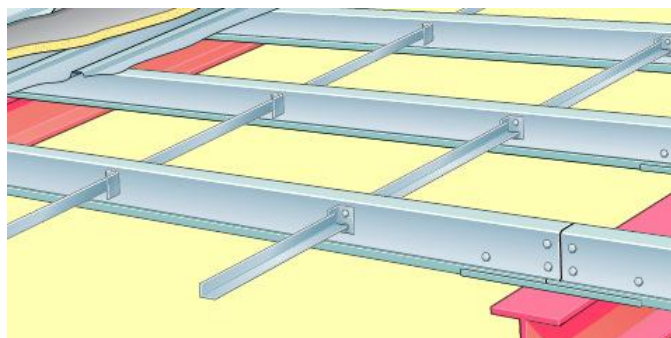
Linhas de travamento de terças (Vieira apud METFORM, 2009)
